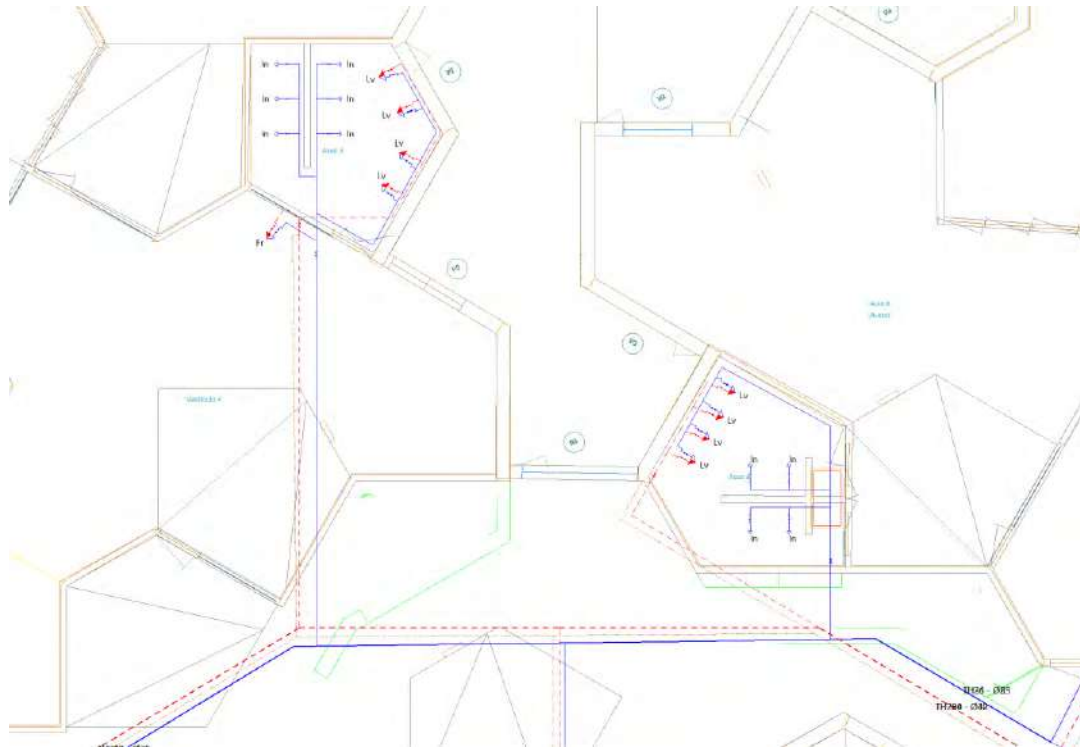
Plano detalle – Fontanería (Ejemplo distribución locales húmedos)
